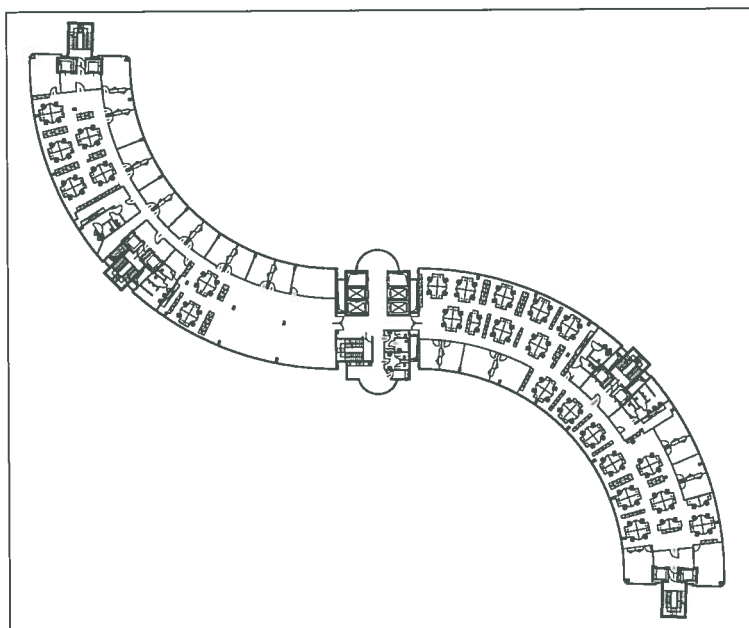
Pianta del piano tipo, dopo la progettazione degli interni.
